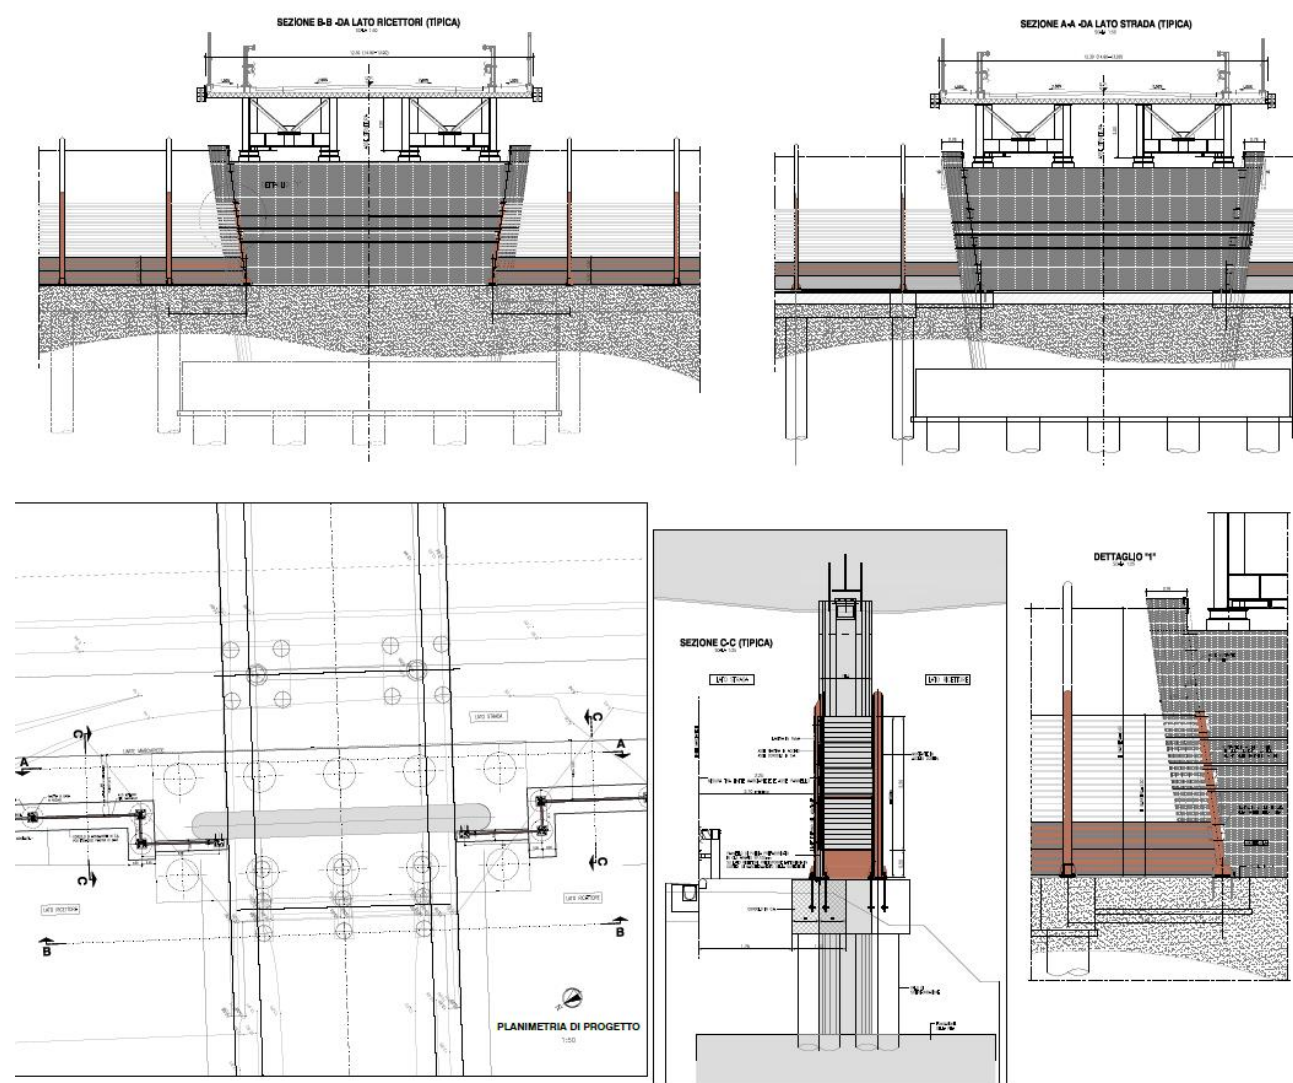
Schema di chiusura delle barriere acustiche sulla spalla dei cavalcavia a tre luci
